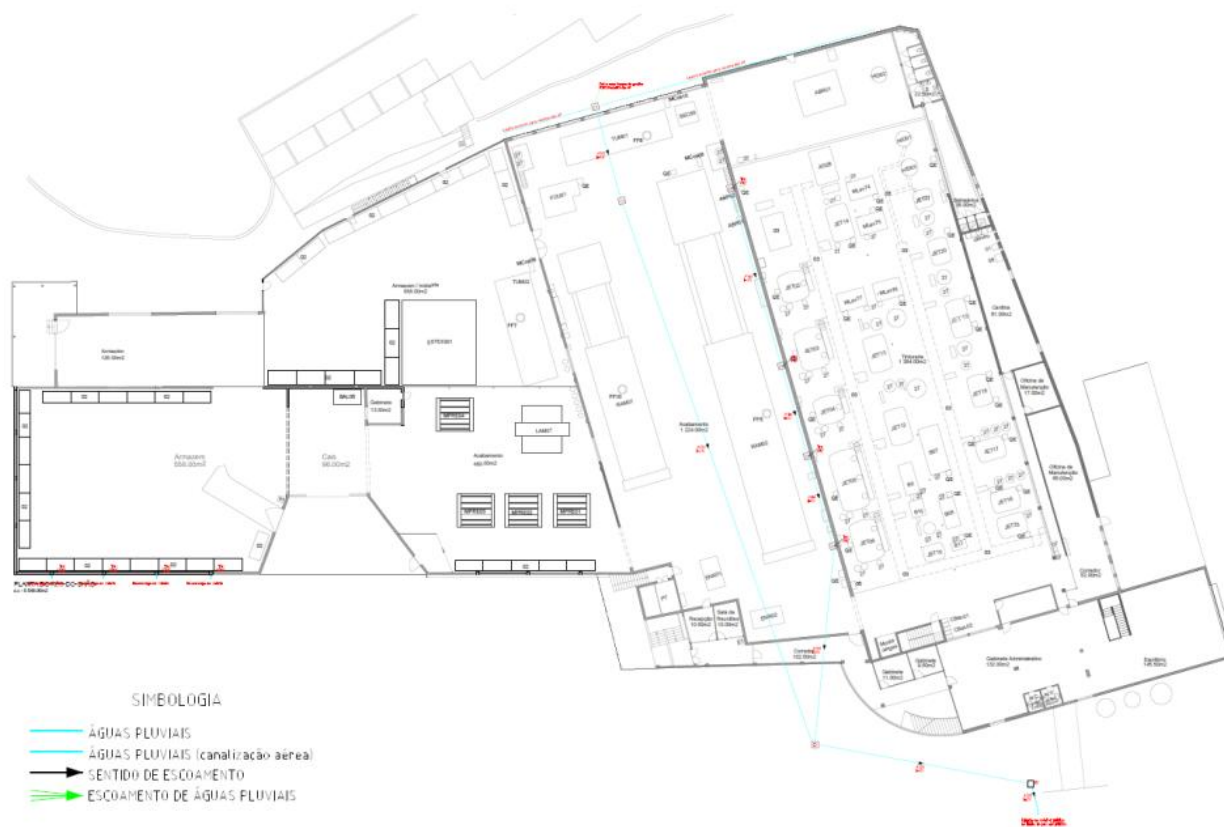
Planta de esquemática da rede de águas pluviais do rés-do-chão do Projeto
